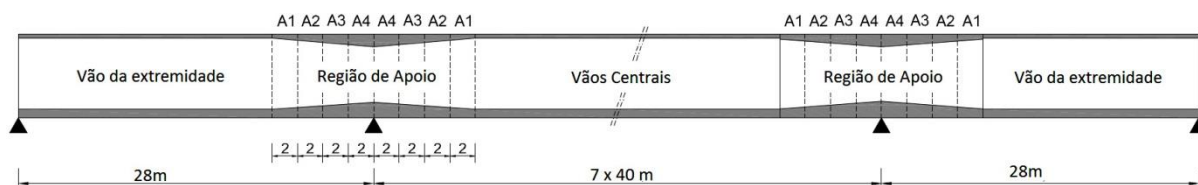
Discretização das vigas metálicas utilizadas na modelação numérica (adaptado de Figueiredo, 2007)
